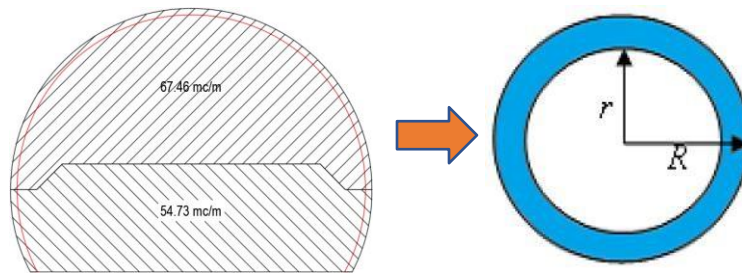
Section anneau équivalente pour la section du tunnel.
